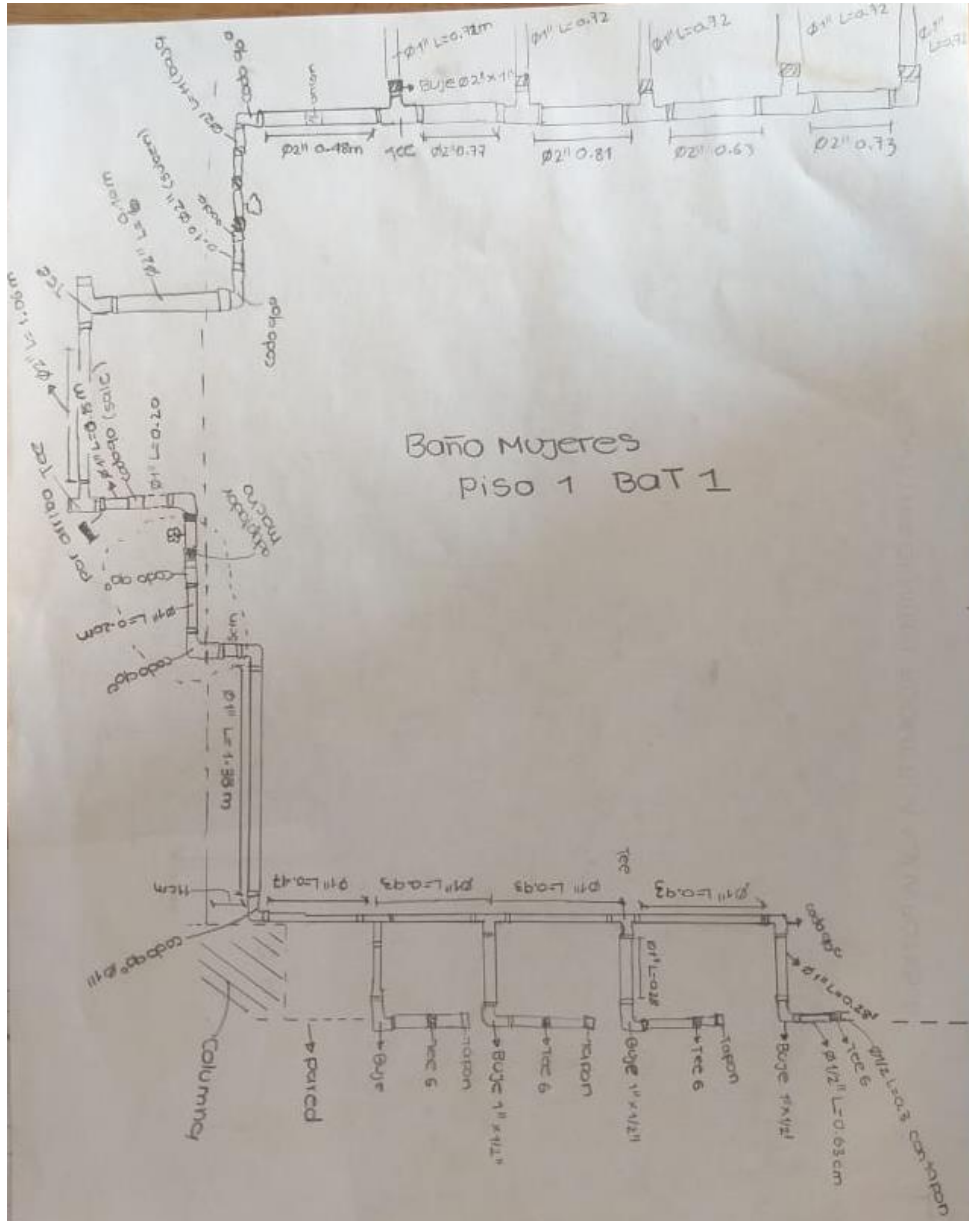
Esquema mano alzada tubería hidráulica baño mujeres, batería 1, piso 1.
